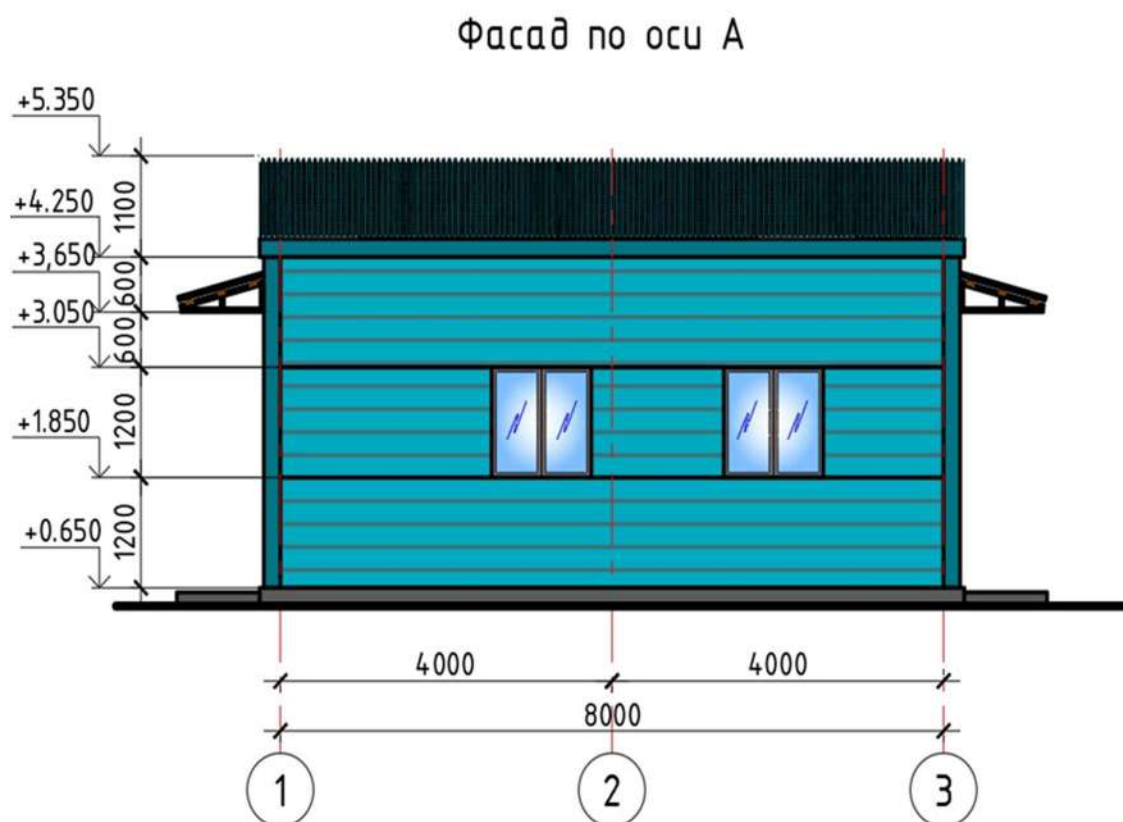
Фасад здания насосной станции пруд накопителя оборотной воды
